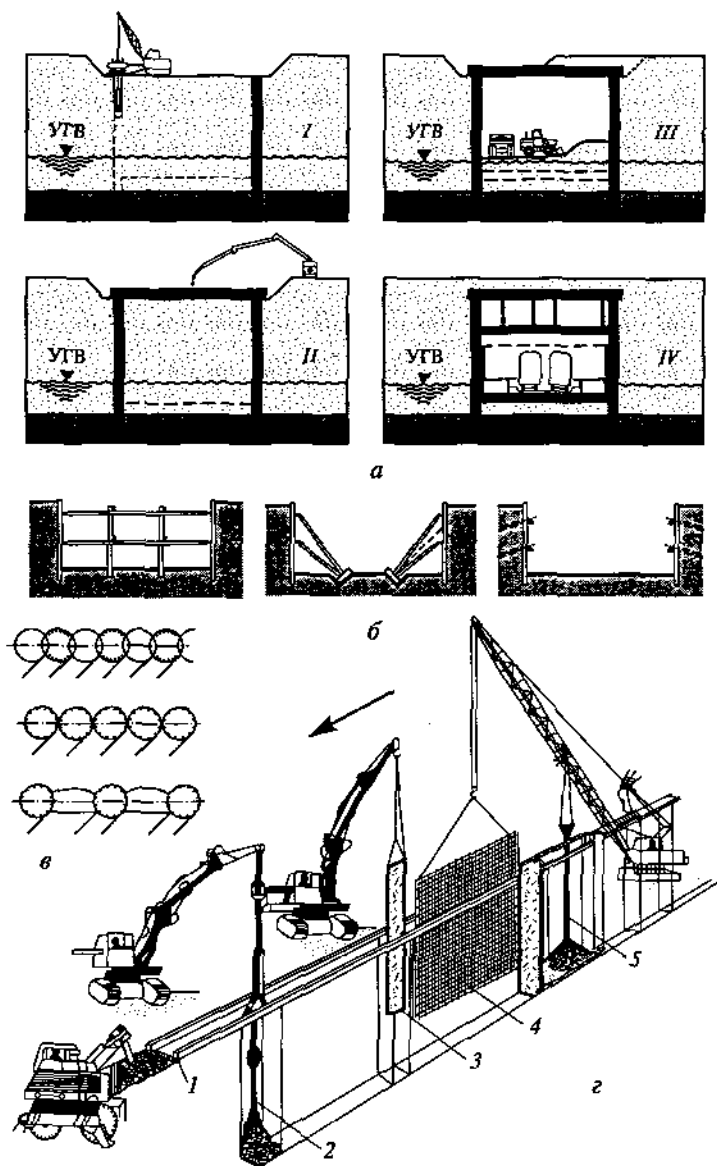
Схемы возведения подземных сооружений методом «стена в грунте»:
